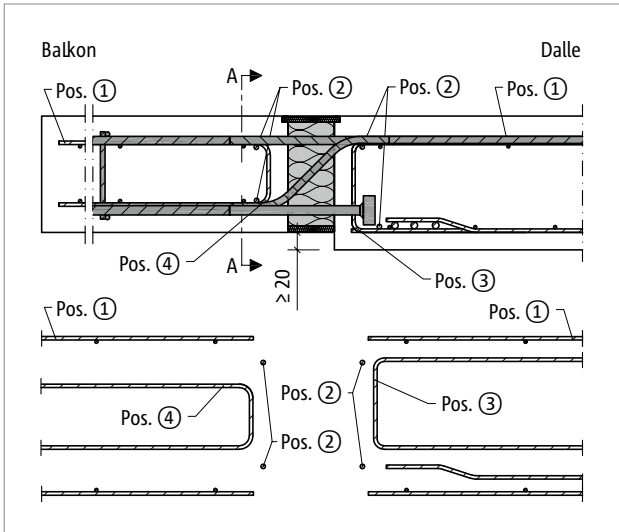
Schöck Isokorb® T type K-T-M13 : renforcement sur site pour support indirect
